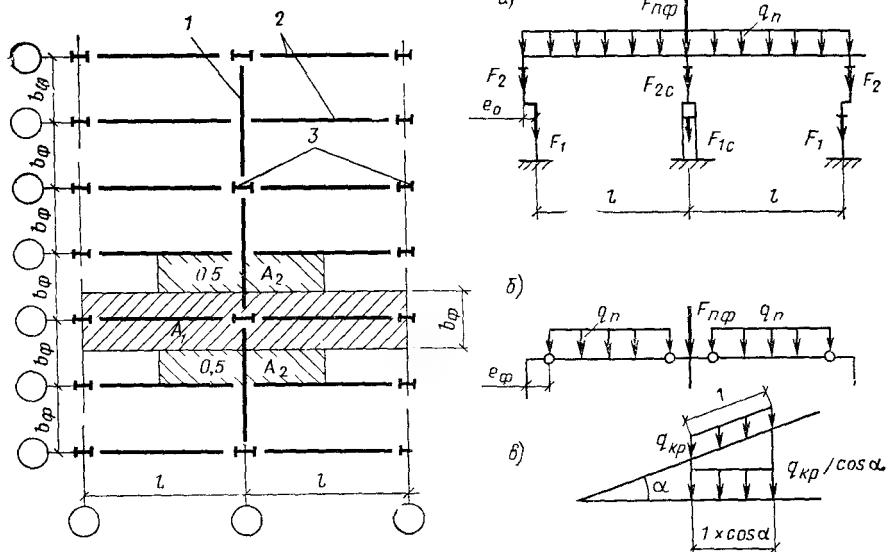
Расчетные схемы рам при расчете на постоянные нагрузки
